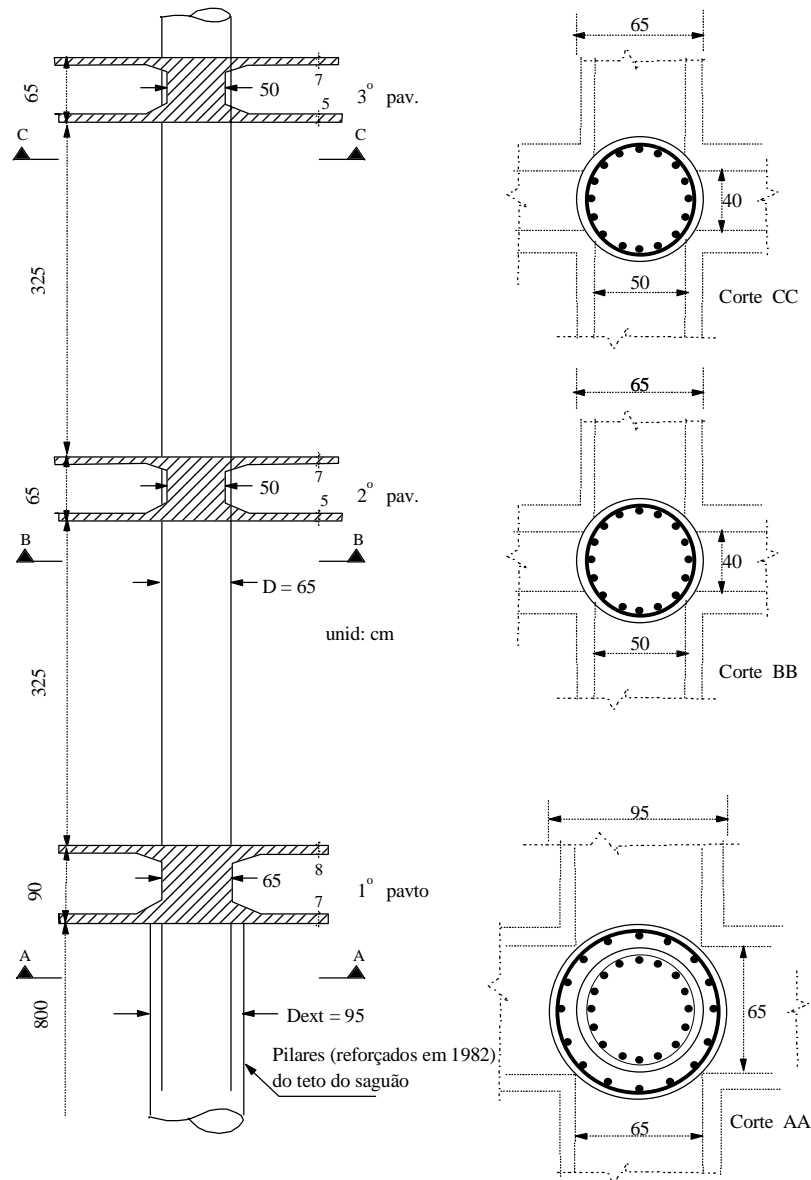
Corte vertical na área do saguão – prumada típica dos pilares e lajes duplas
